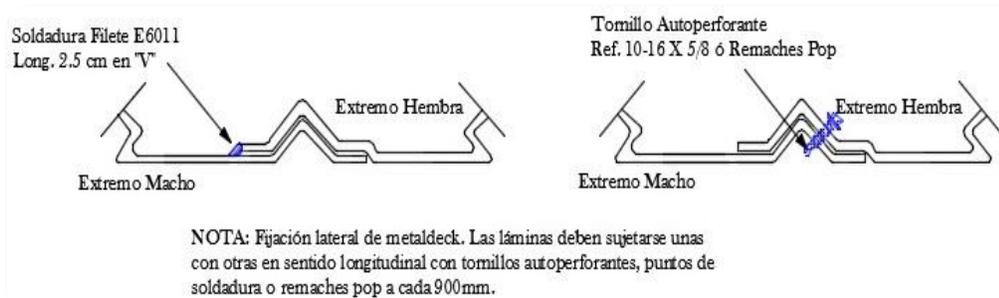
Detalle transversal del sistema de losa con metaldeck
